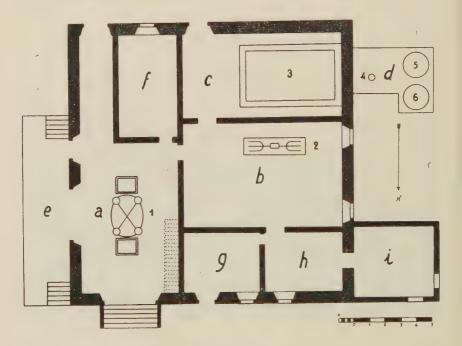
Pianta schematica dello stabilimento dell'U. T. I. C. S. ad Azizia per la pressatura dell'alfa.
